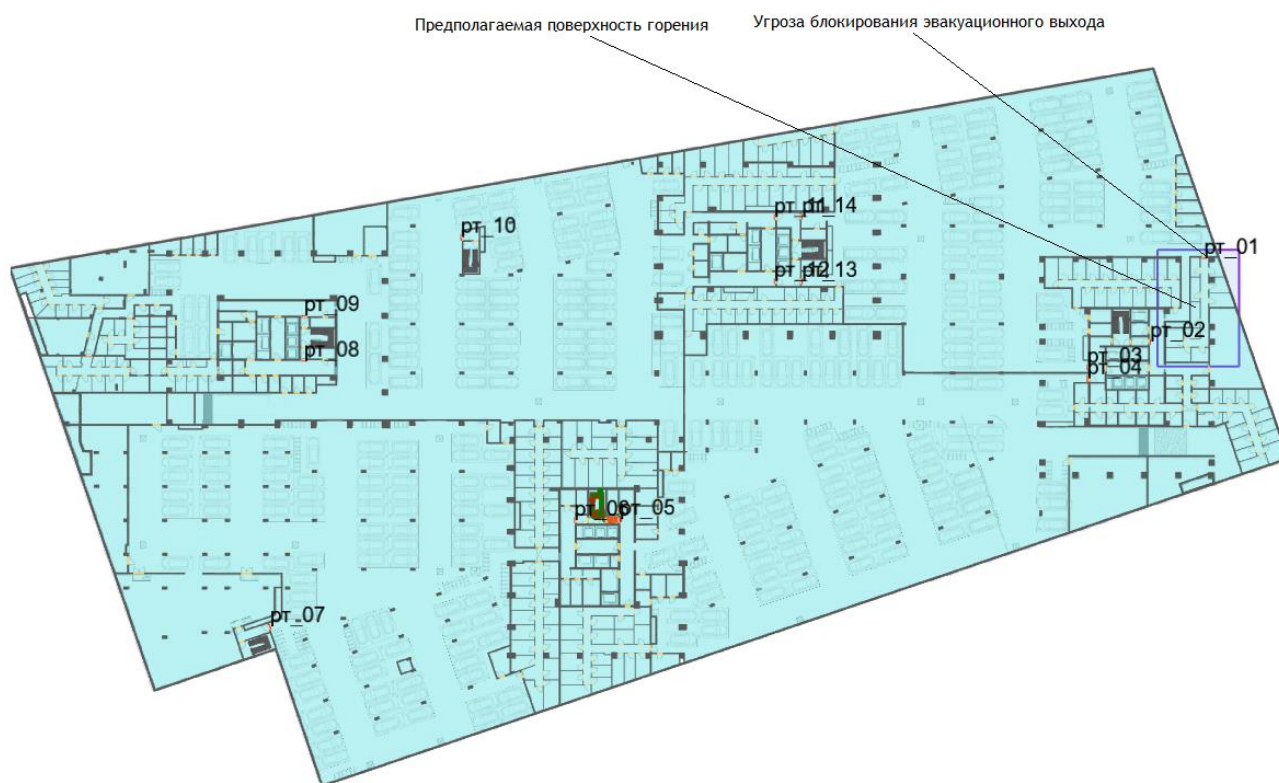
План минус 2-го этажа и нанесенная на него расчетная (принципиальная) схема эвакуации (расположение людей на момент полной эвакуации с этажа пожара – 4 мин.59 сек.)
